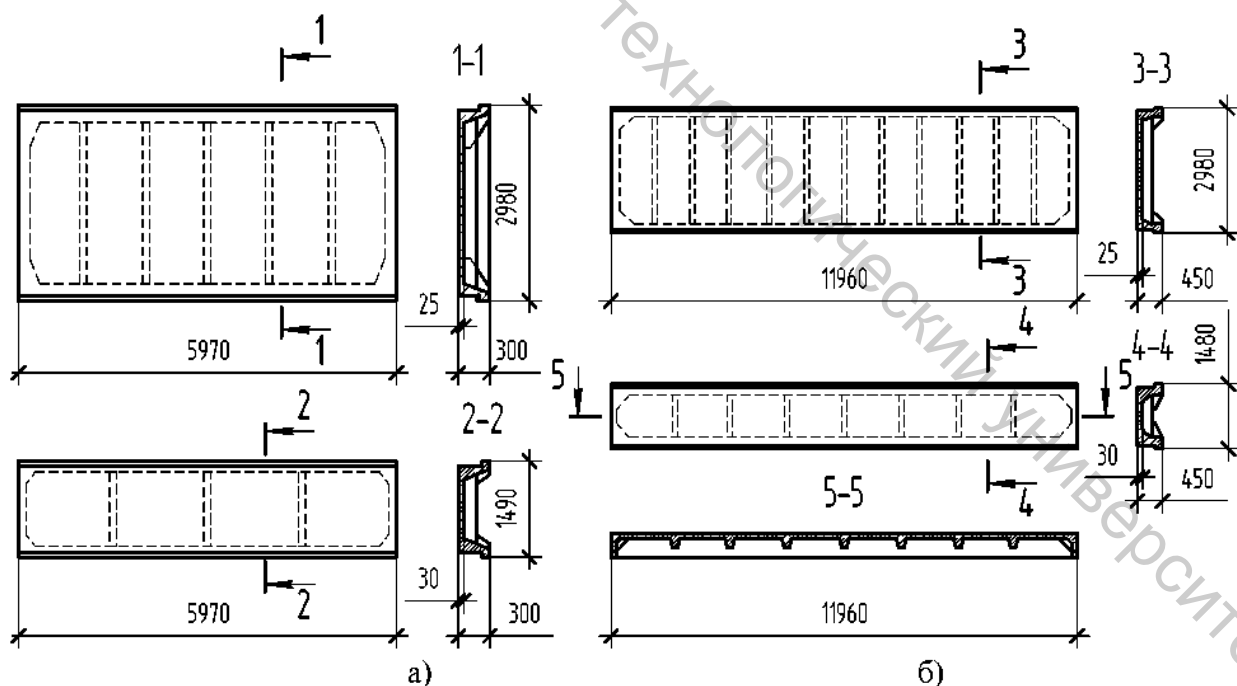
Железобетонные плиты покрытий: а – ребристые размером 3×6 и 1,5×6 м; б – то же, 3×12 и 1,5×12 м
